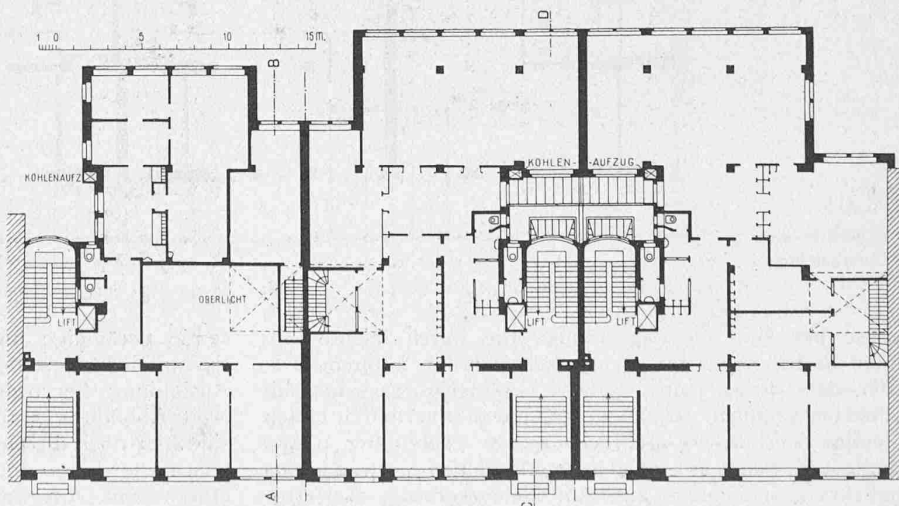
Grundriss vom hochliegenden Erdgeschoss. — Masstab 1:400.
